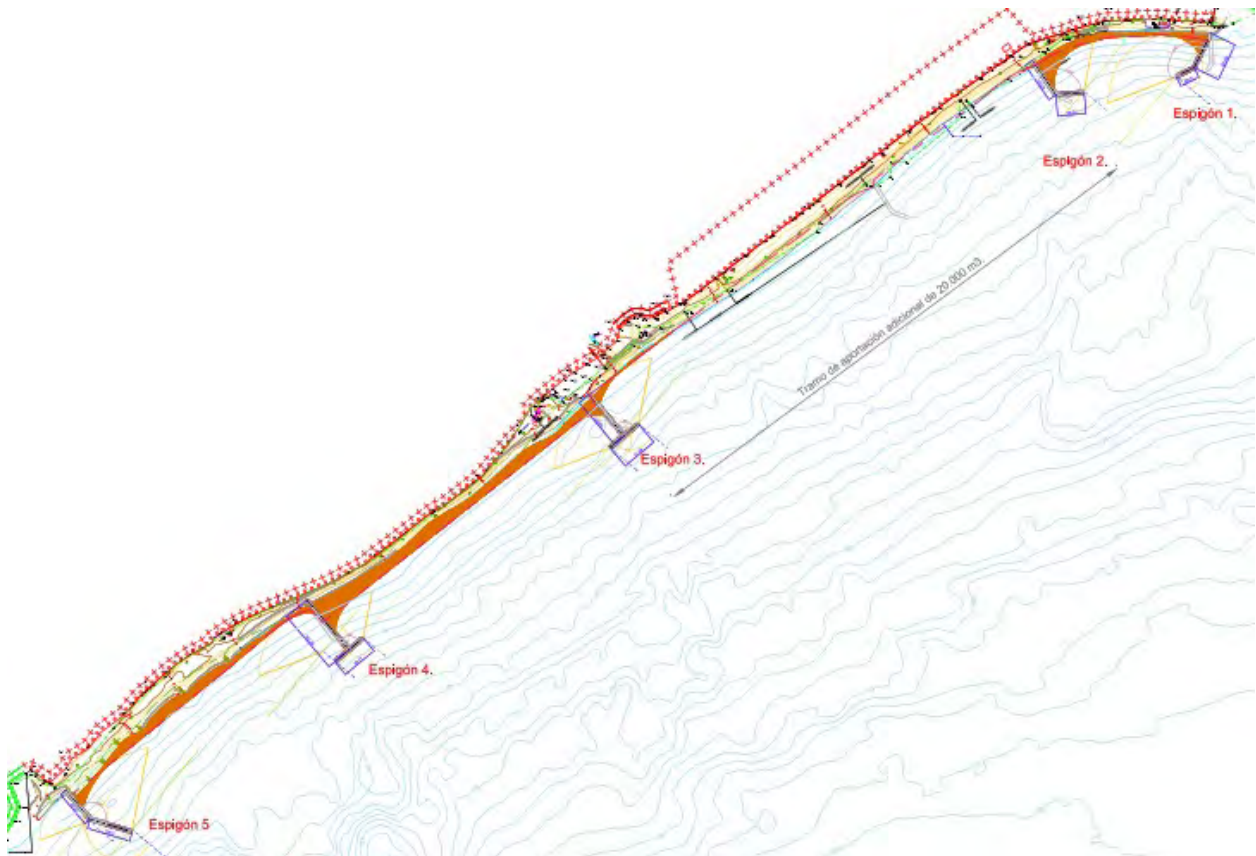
Planta final de la fase 1 (Fuente: Proyecto constructivo 2018)
